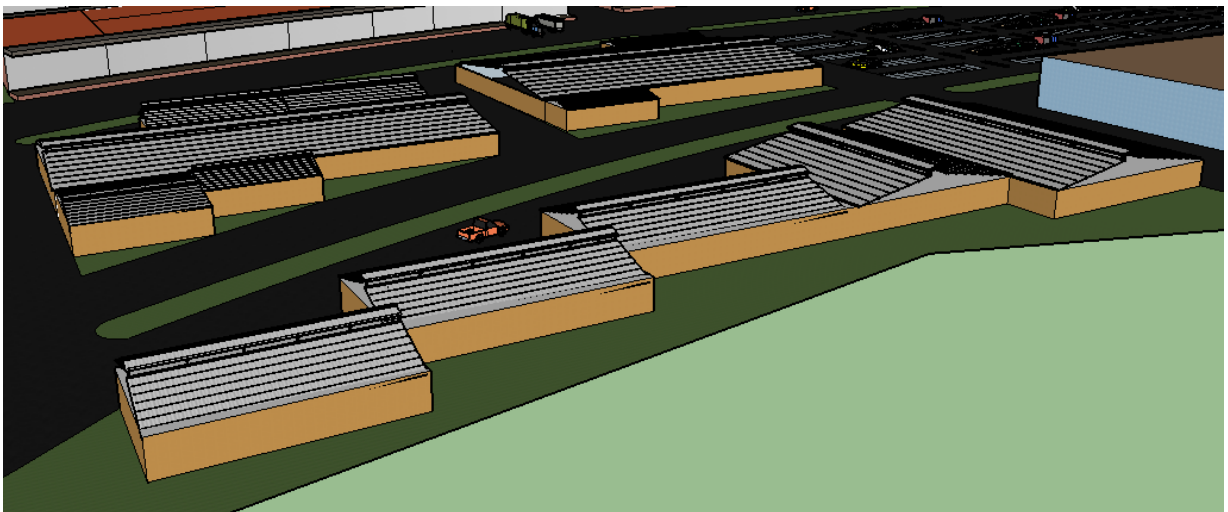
Render en donde se aprecia en primer plano las naves destinadas a la venta de abarrotos y semillas, cada nave está proyectada a un solo piso con una altura de 4.00 metros.
